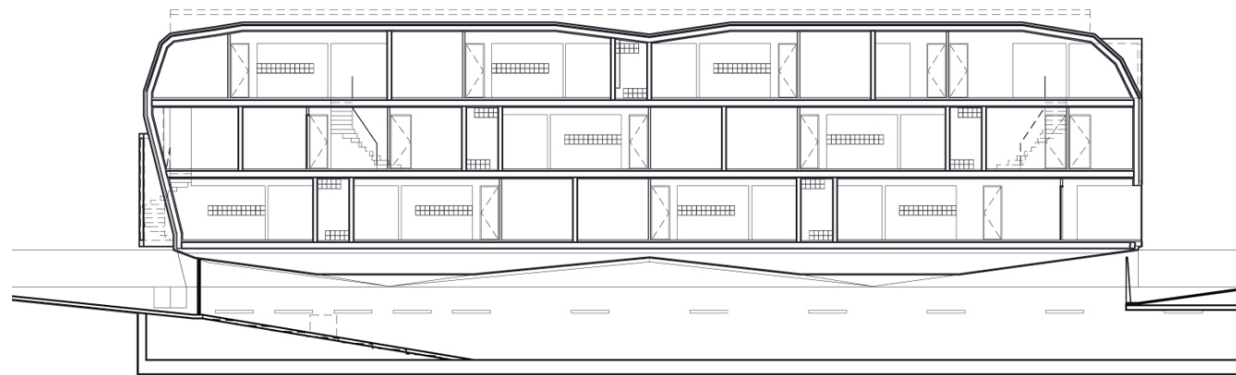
Imagen detalle constructivo Koidula Apartment Building
